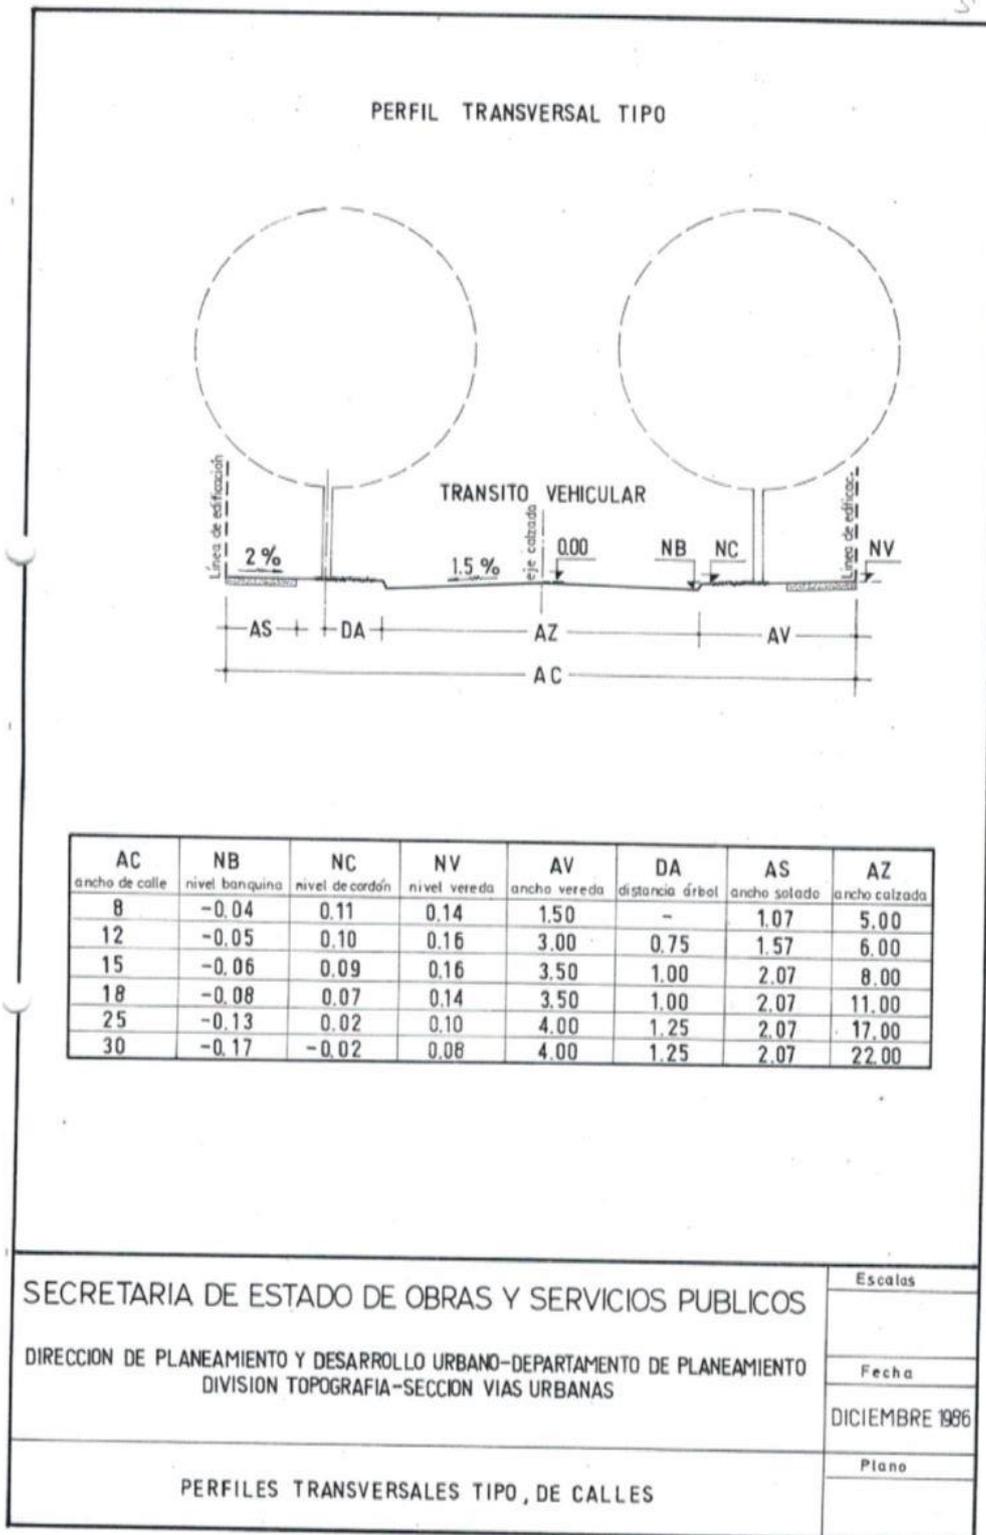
Perfiles transversales tipo de calles, D.P.D.U., San Juan. Fuente: D.P.D.U.
